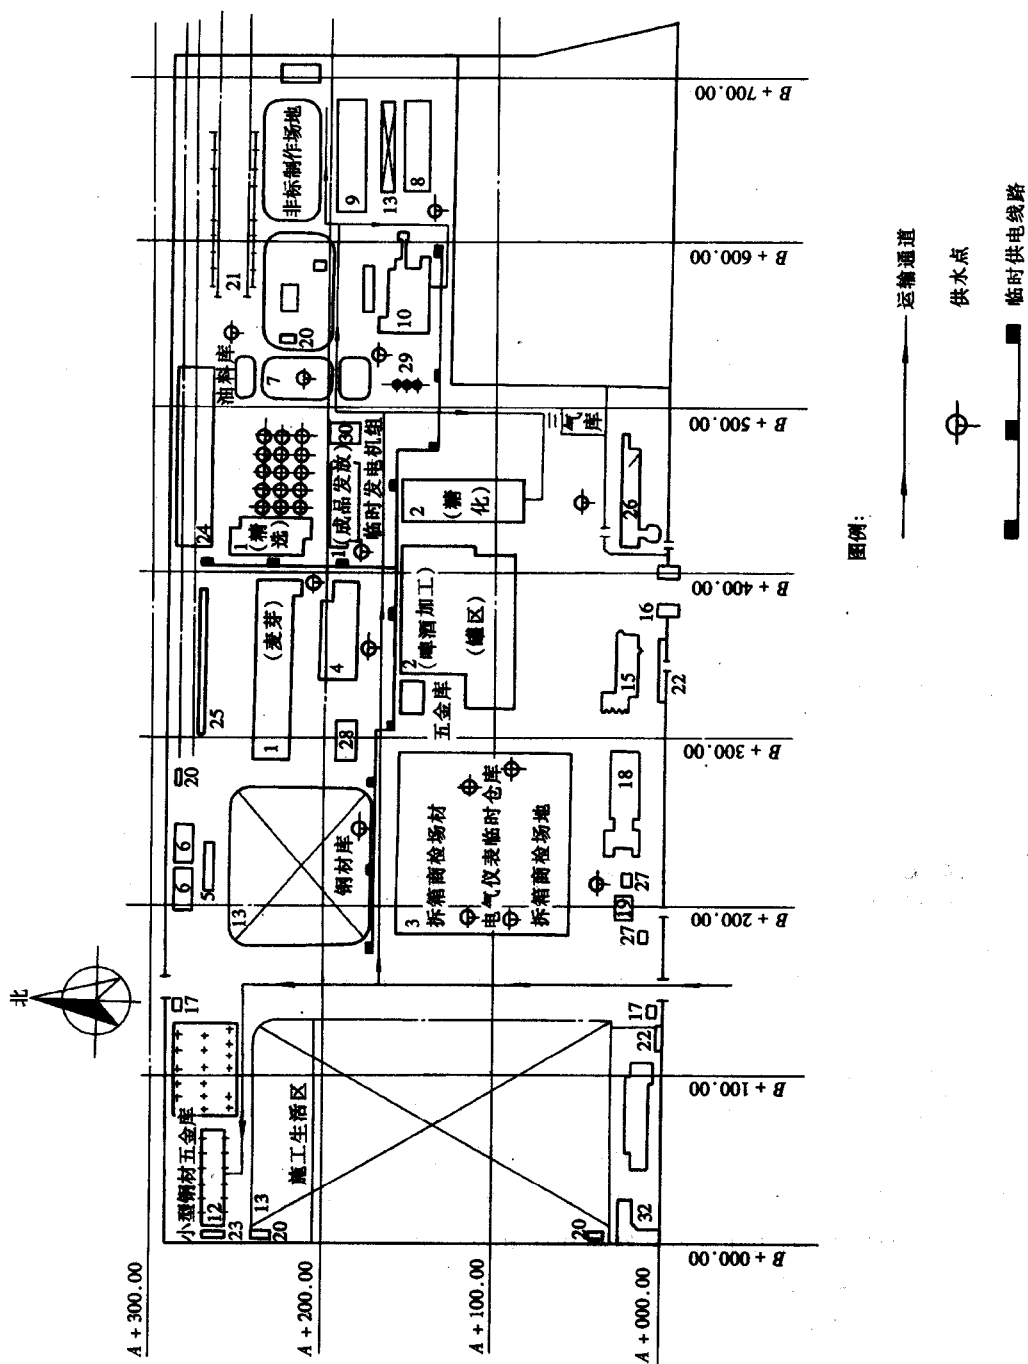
某啤酒厂工程施工现场平面布置图(单位:m)
